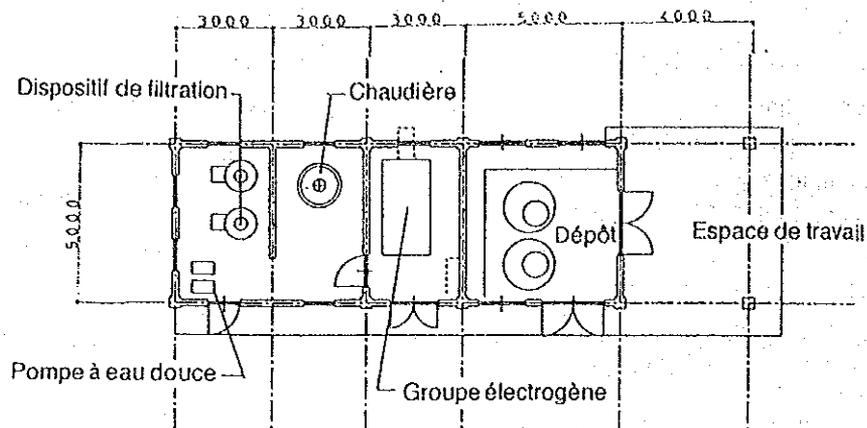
Plan du bâtiment des machines 90,0 m²
